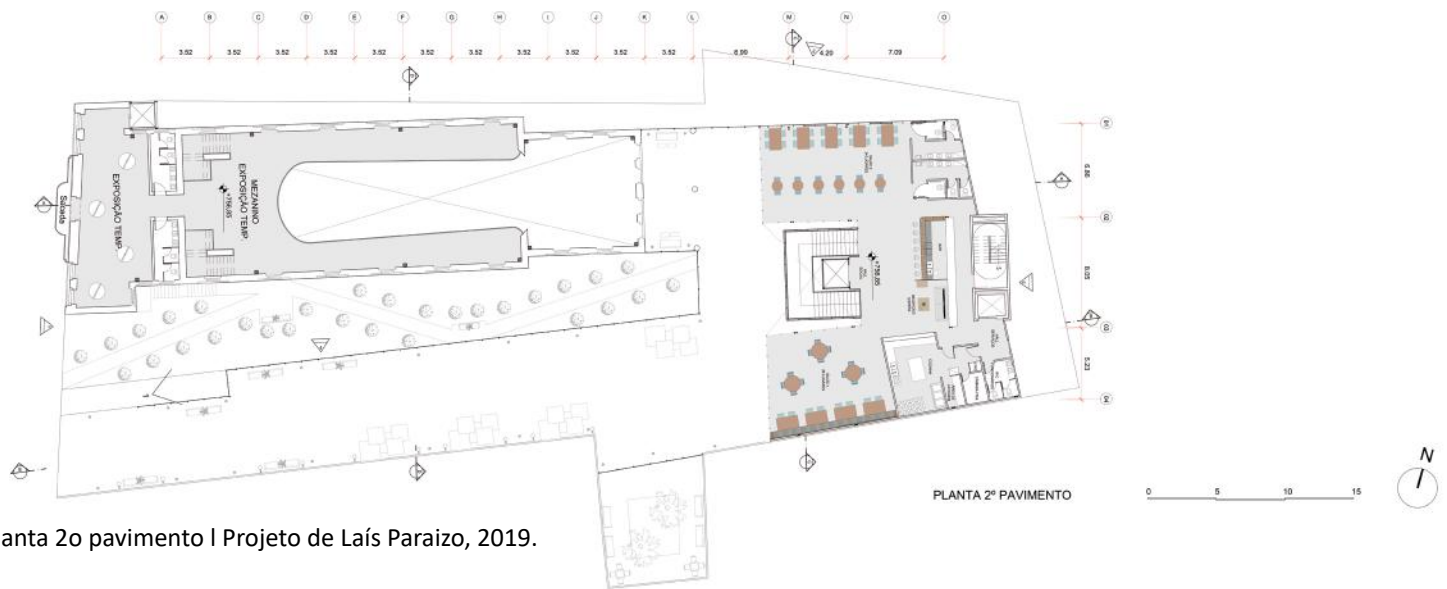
Planta 2o pavimento | Projeto de Laís Paraizo, 2019.
